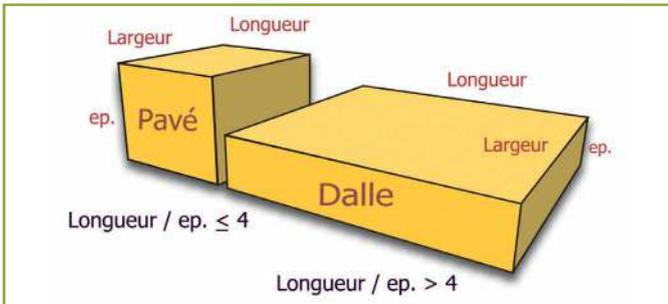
Schéma des pavés et dalles en béton (Dessin de C. Houel)
